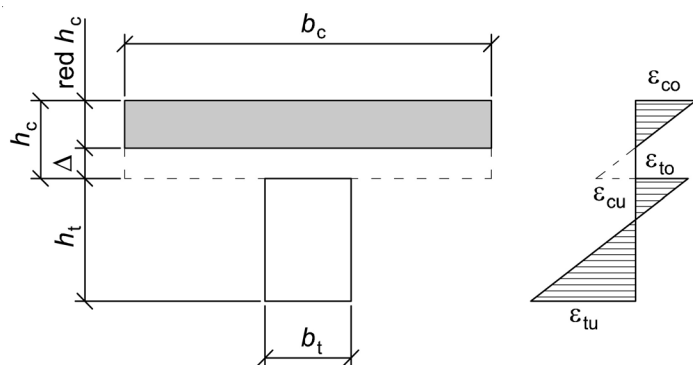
Berücksichtigung der Rissbildung des Betons
